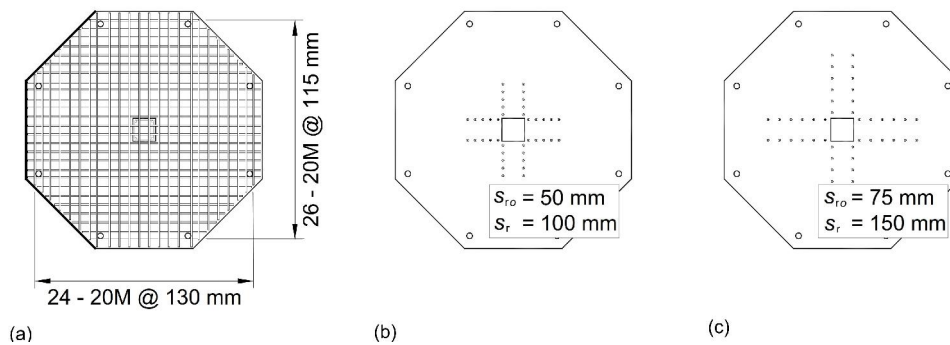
Armadura de flexão e disposição dos "studs": (a) Armadura de flexão das lajes 7 a 9; (b) Disposição dos "studs" na laje 8; (c) Disposição dos "studs" na laje 9 [8].
